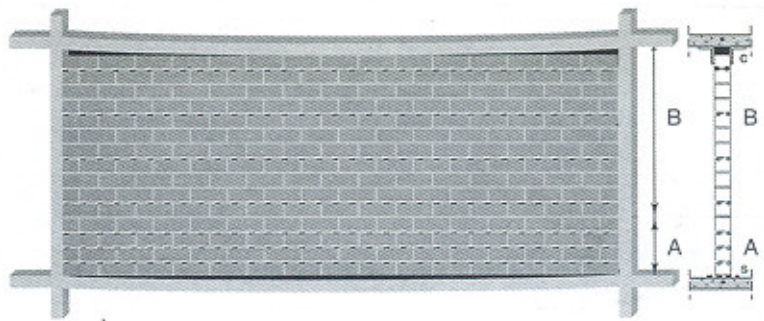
Muro sin armar, muro de fábrica armada con Murfor.
